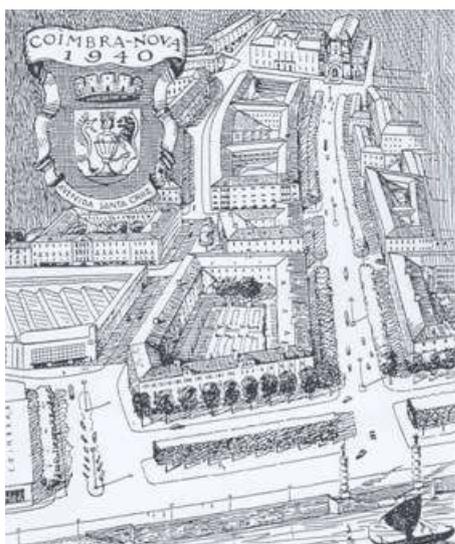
Avenida de Santa Cruz proposta para a Baixa de Coimbra (Gröer, 1940, 48).
